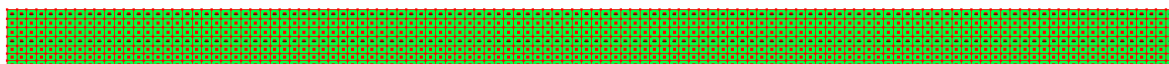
Armatura longitudinale intradosso ed estradosso fondazione
